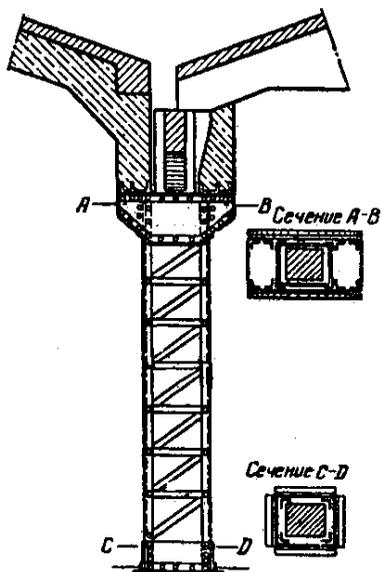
Усиление железобетонных колонн путем применения металлических разгружающих конструкций (“Wiederherstellungsarbeiten im Eisenbetonbau”, “Armierter Beton”, 1914, с. 138–144)
